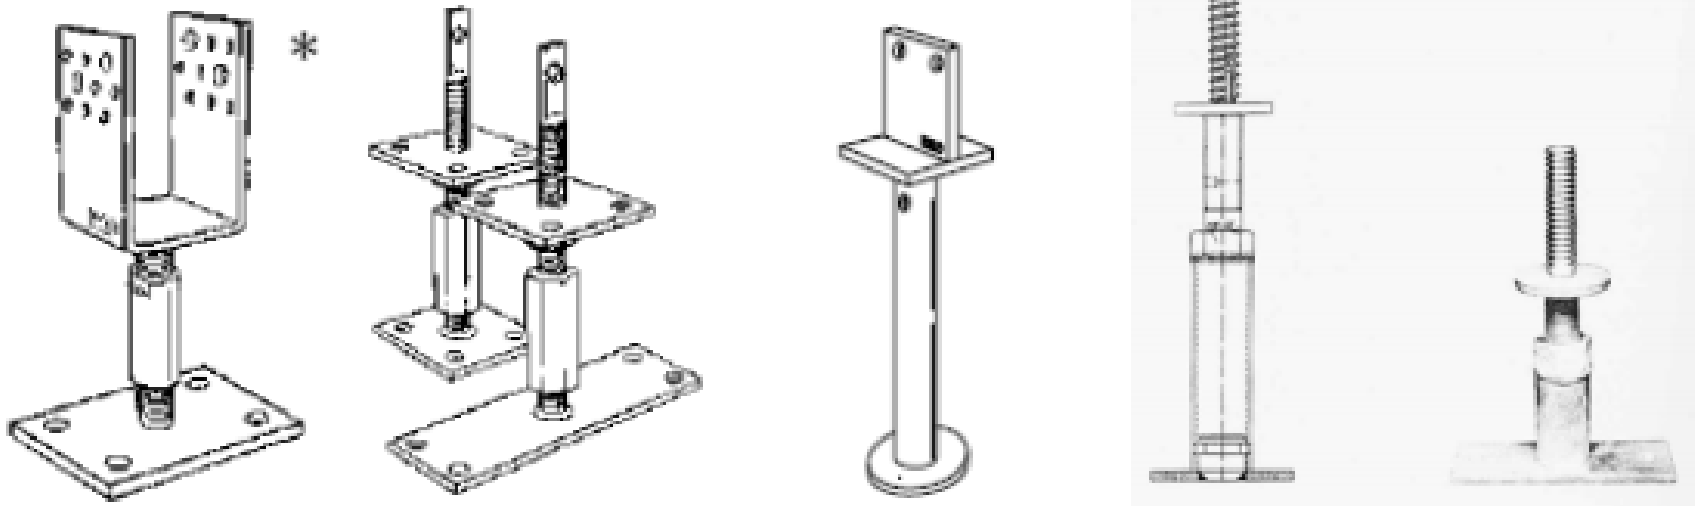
Algunos tipos de bases regulables para pilares de madera: se apoyan sobre placas de montaje o se hormigonan directamente. Los tres primeros marca Bilo, los últimos dos son Top-Foot.
